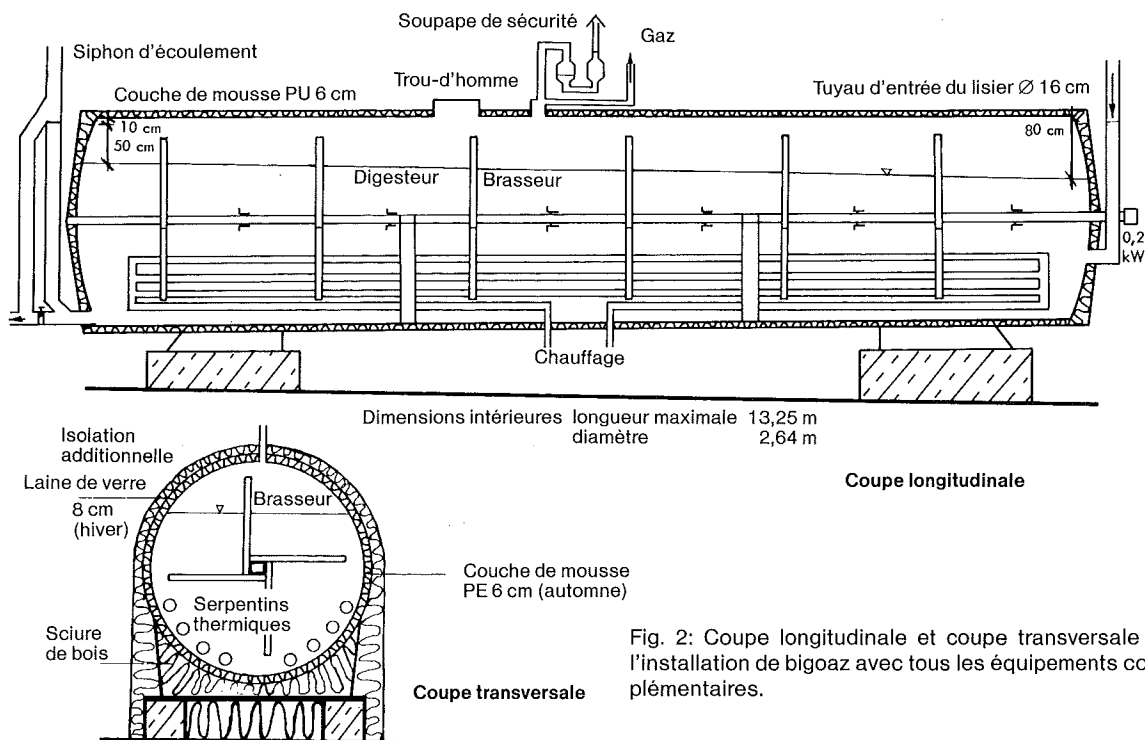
Coupe longitudinale et coupe transversale de l'installation de bigoaz avec tous les équipements complémentaires.
